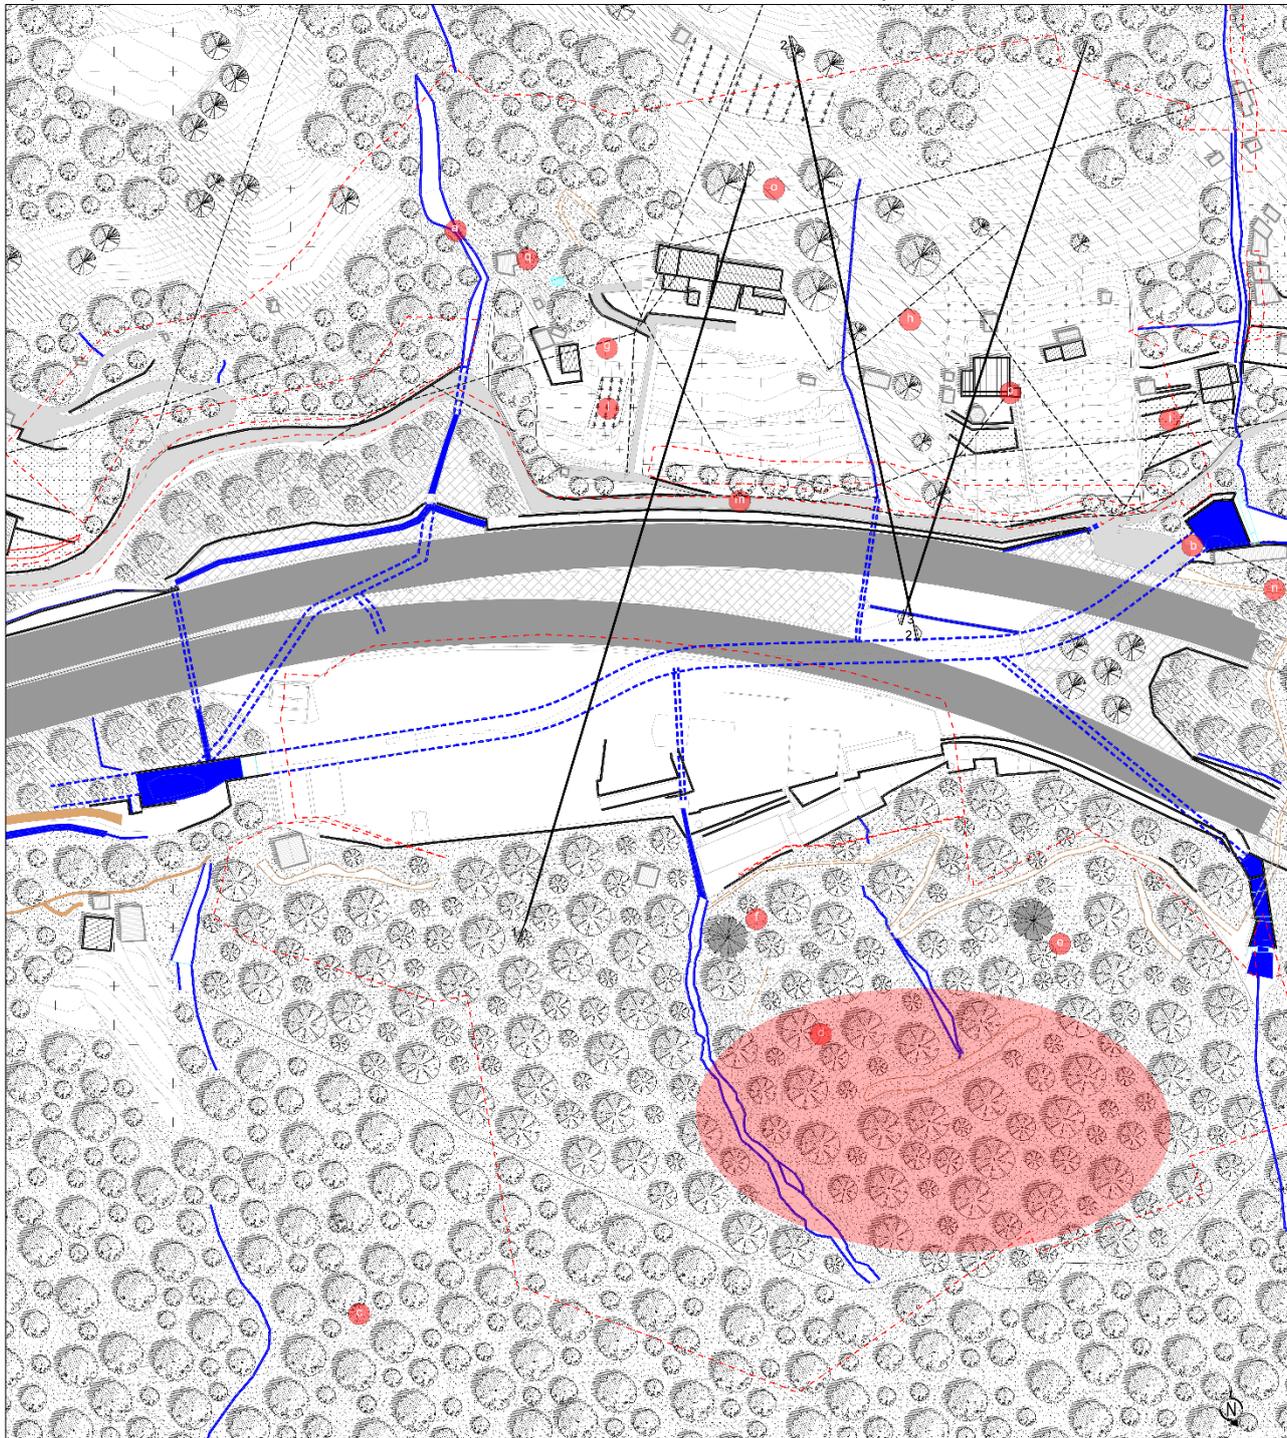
Estratto planimetria semiologia antropica (in rosso limiti delle aree di imbocco)
